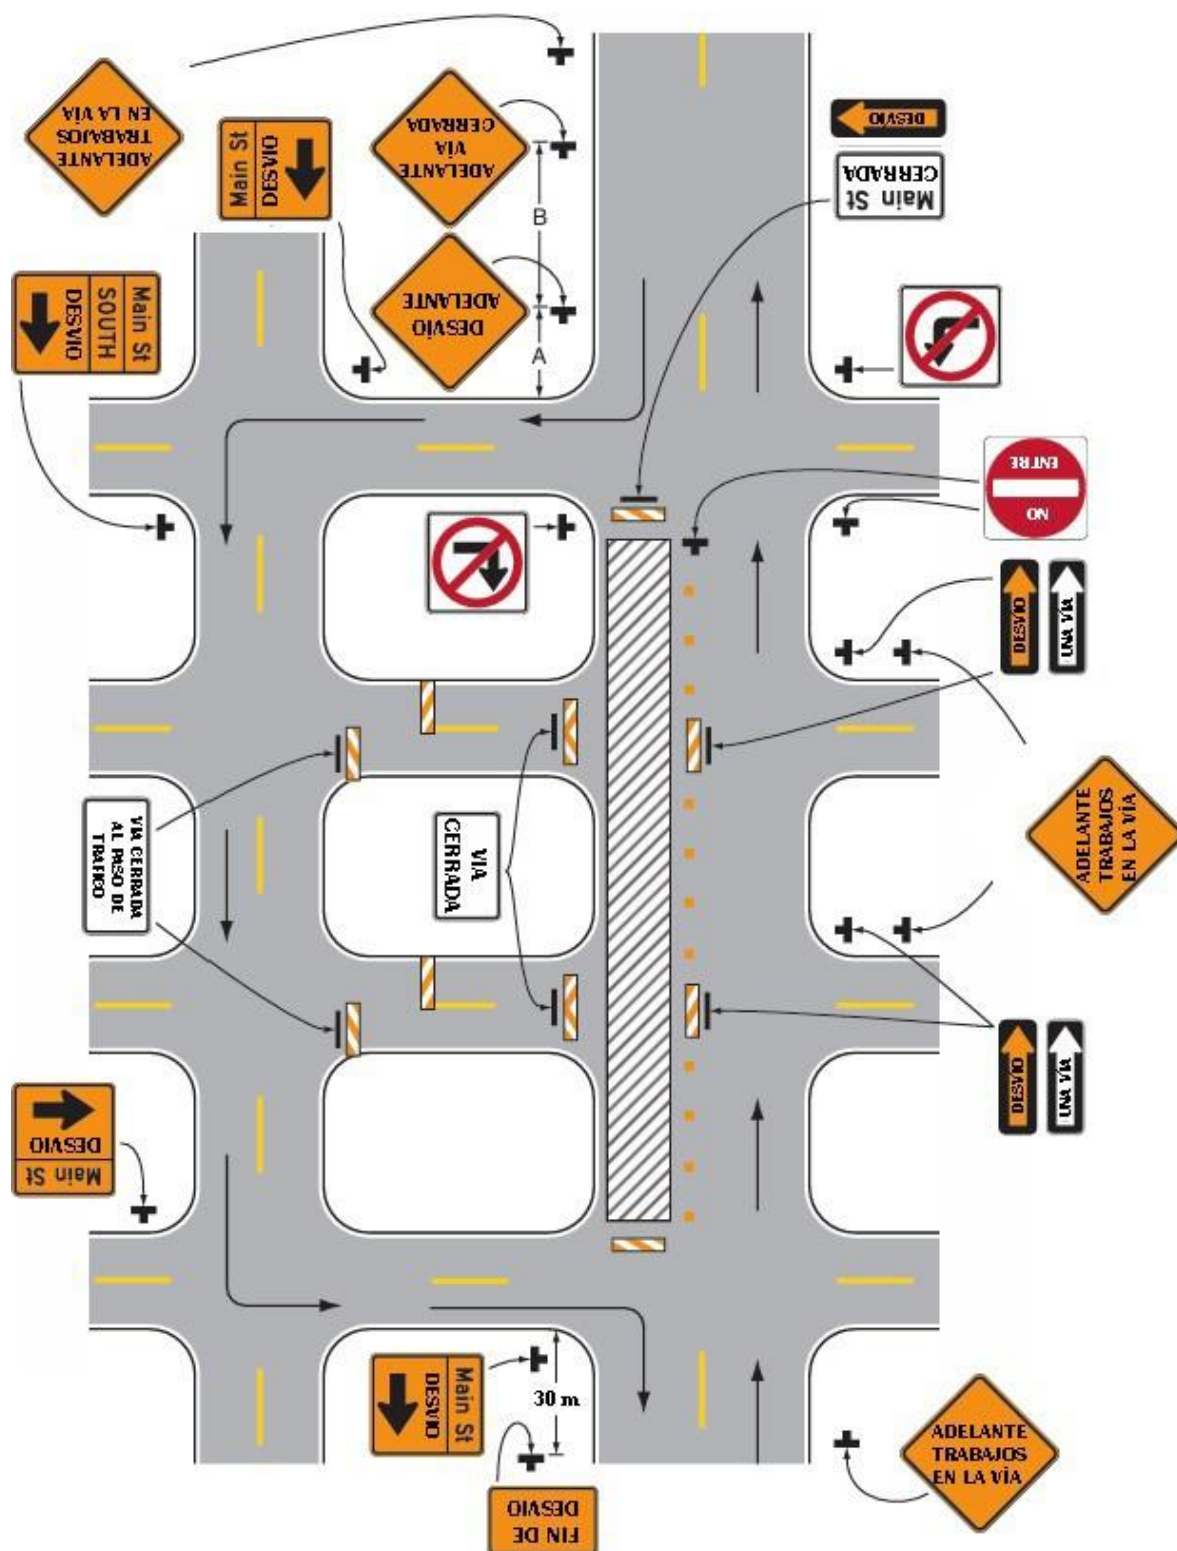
MTT para desvío de carril en un solo sentido de viaje.
